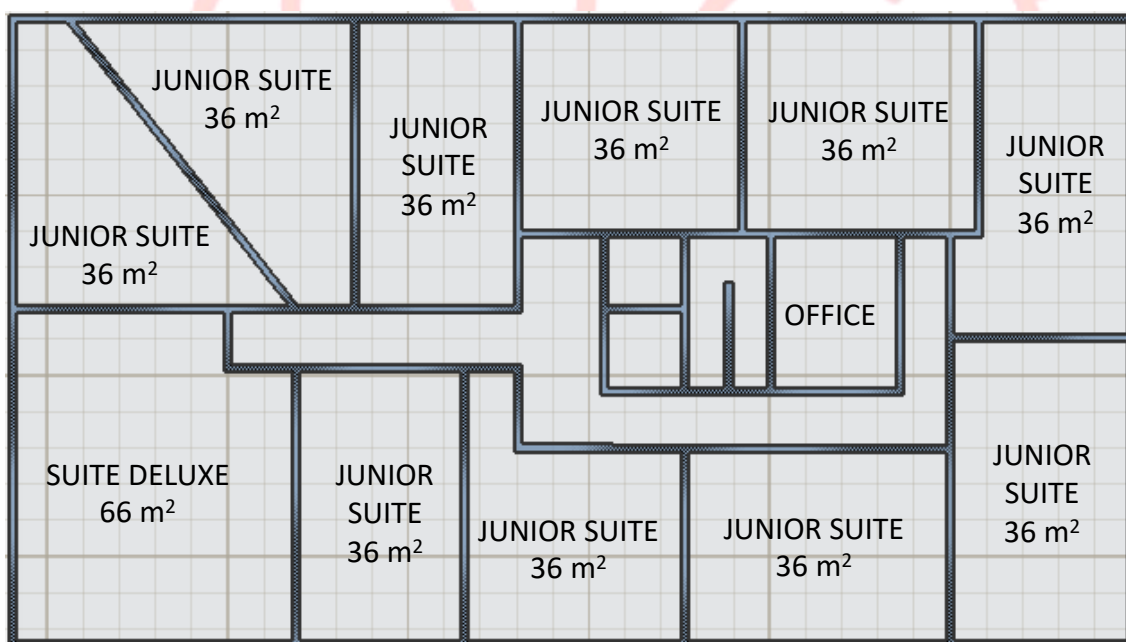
Planos: Planta 4, Suites. Fuente: Elaboración Propia
